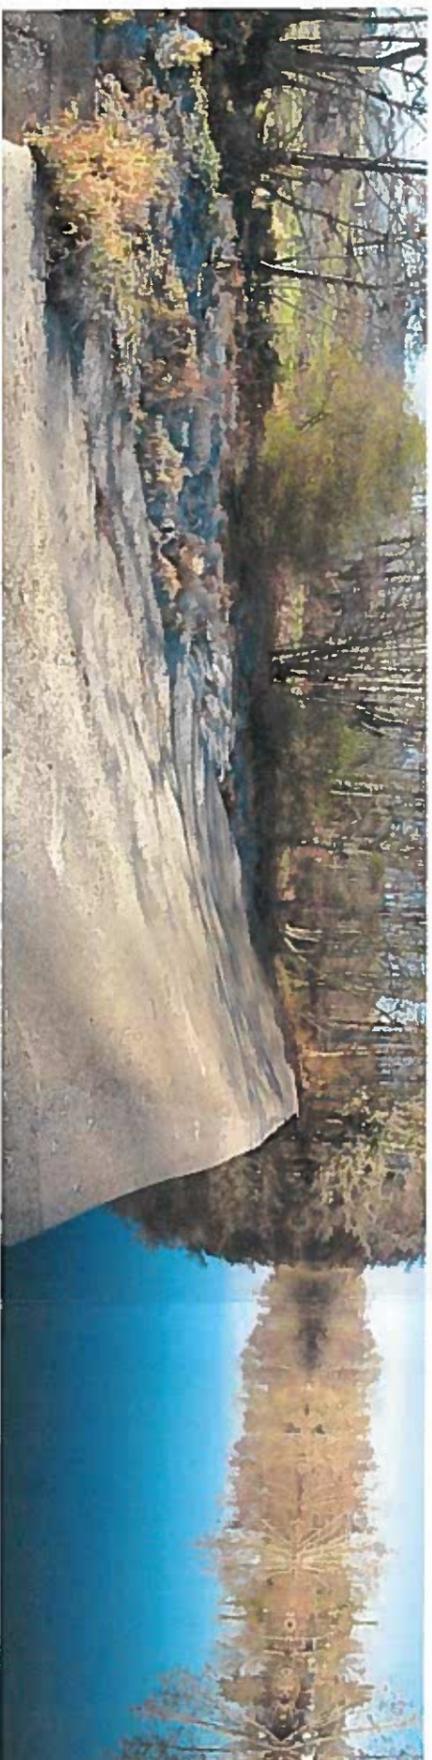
Angle amont du barrage ; Implantation des vis et de la passe à poissons en projet
